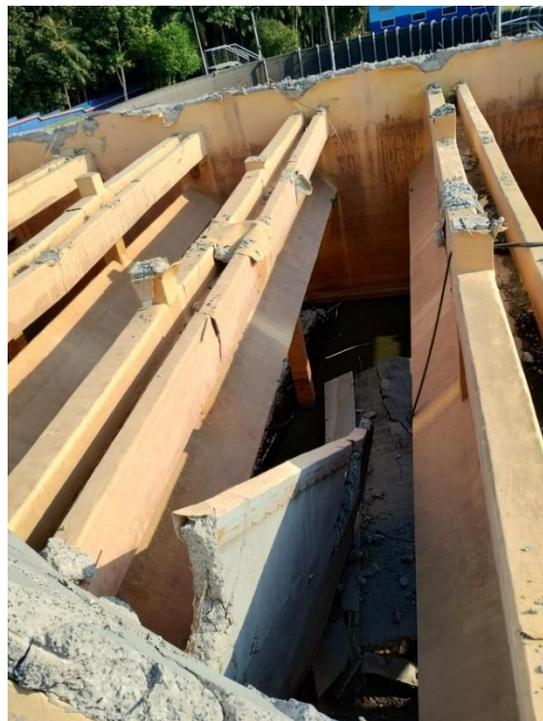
Partes da estrutura a serem demolidas ainda presas nas estruturas existentes.
